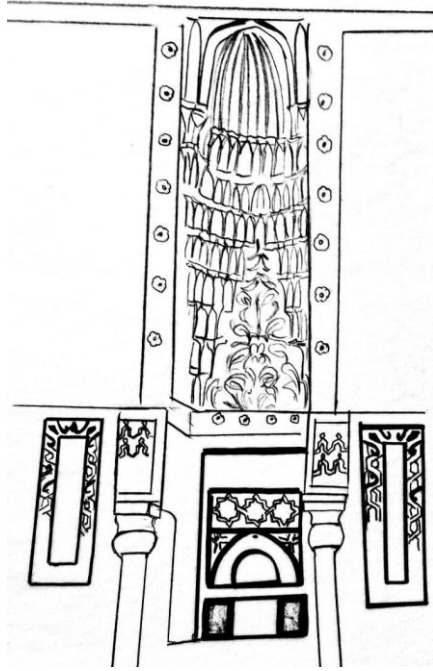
مسقط تخيلي لما كان عليه الطابق الأول من منشأة حدرة البقر التي انشأها مصطفى اغا بن عبد الرحيم بمعرفة الباحث
